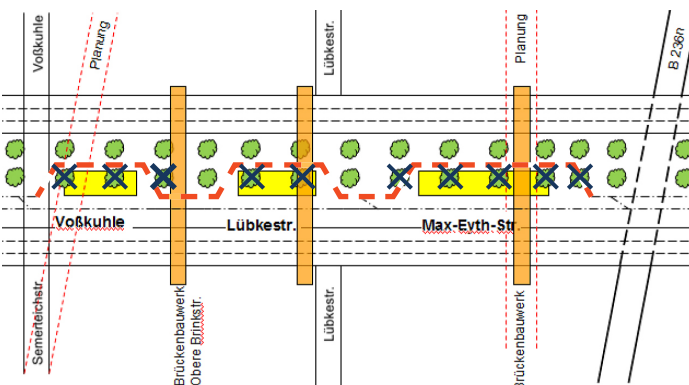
Planschema, das weder Stadtbahn noch Allee gerecht wird: Zukunft?
